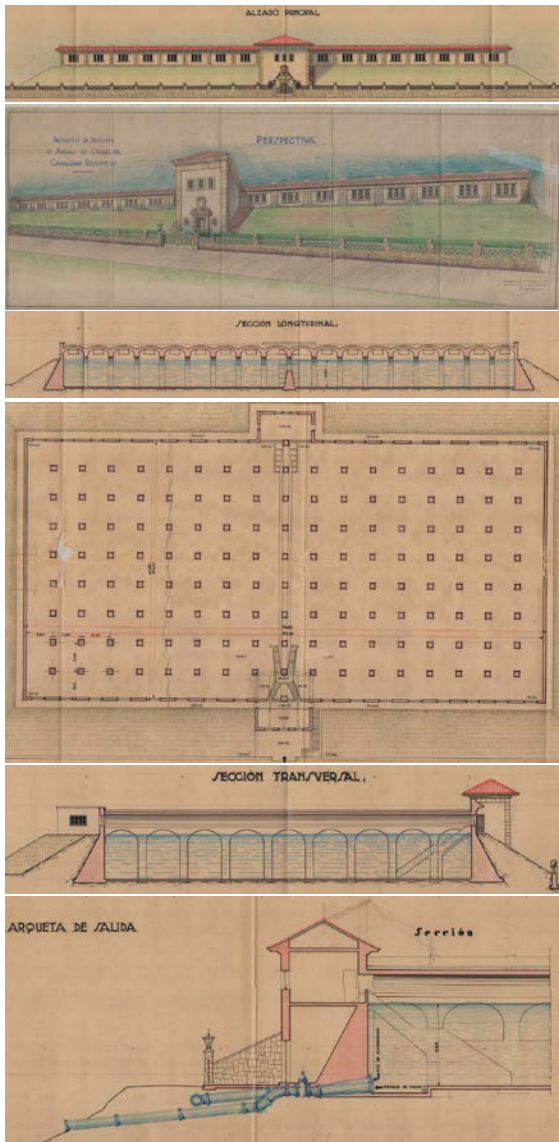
Conjunto de planos de Oriaventa (AM)
